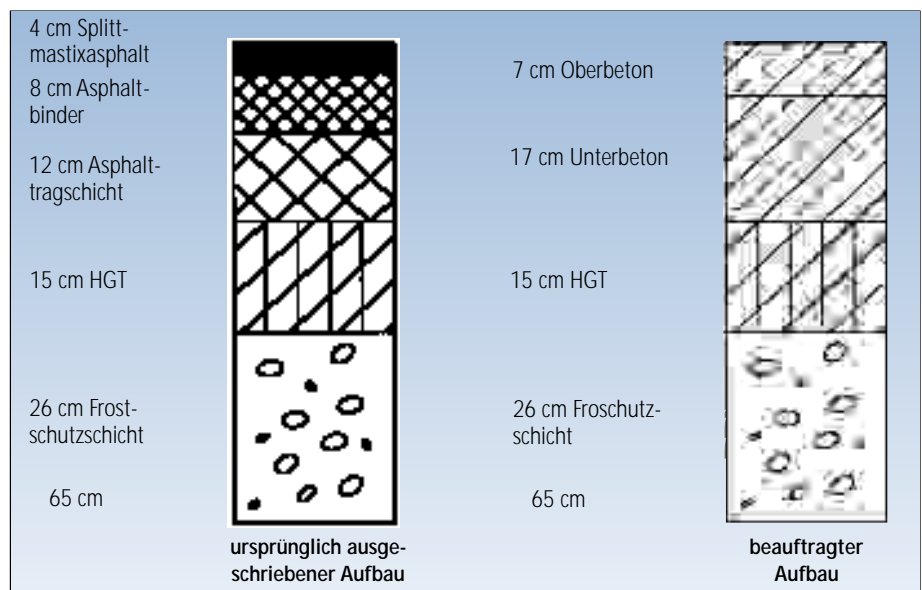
Ursprünglich als Asphaltaufbau ausgeschrieben, wurde ein Betonbau beauftragt, da Fahrbahndecken aus Beton für hochbelastete Verkehrsflächen deutliche Vorteile haben.
